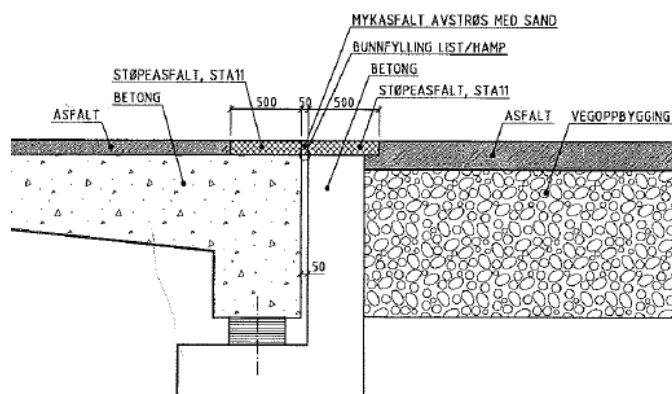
Asfaltfuge med trapping og betongelement (fra rapporten Asfaltfuger på E18 i Vestfold [7])
